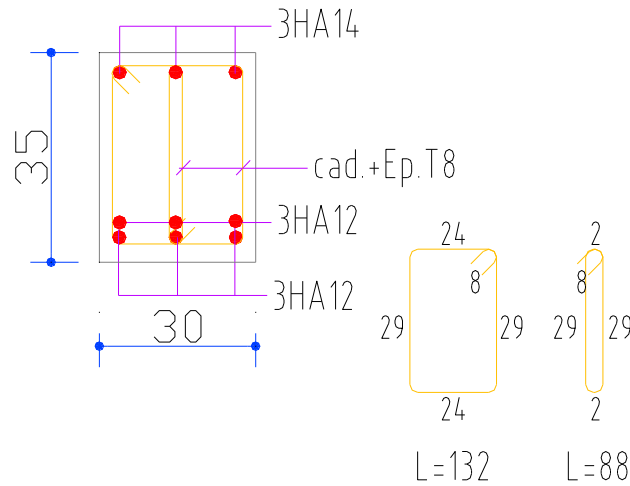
Ferrailage des poutres secondaires au niveau de travée de 4^{ème} à 7^{ème} étage.
